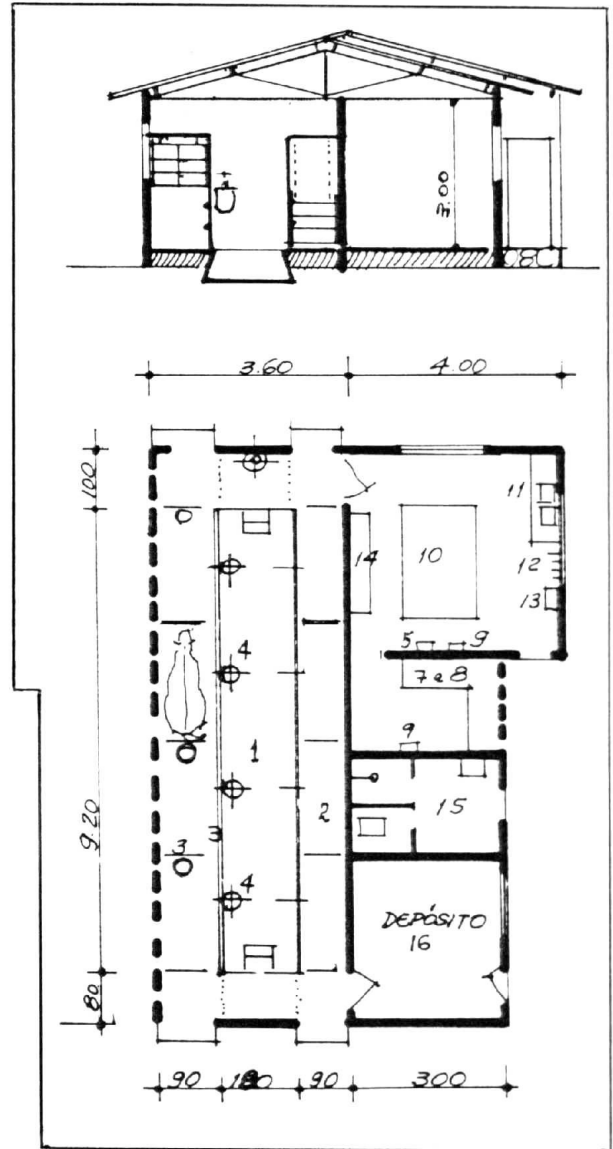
Corte vertical transversal e planta baixa de estábulo com sala de leite modelo (M-9) (Sala de ordenha "Walk-through" 2 x 4 em paralelo).
